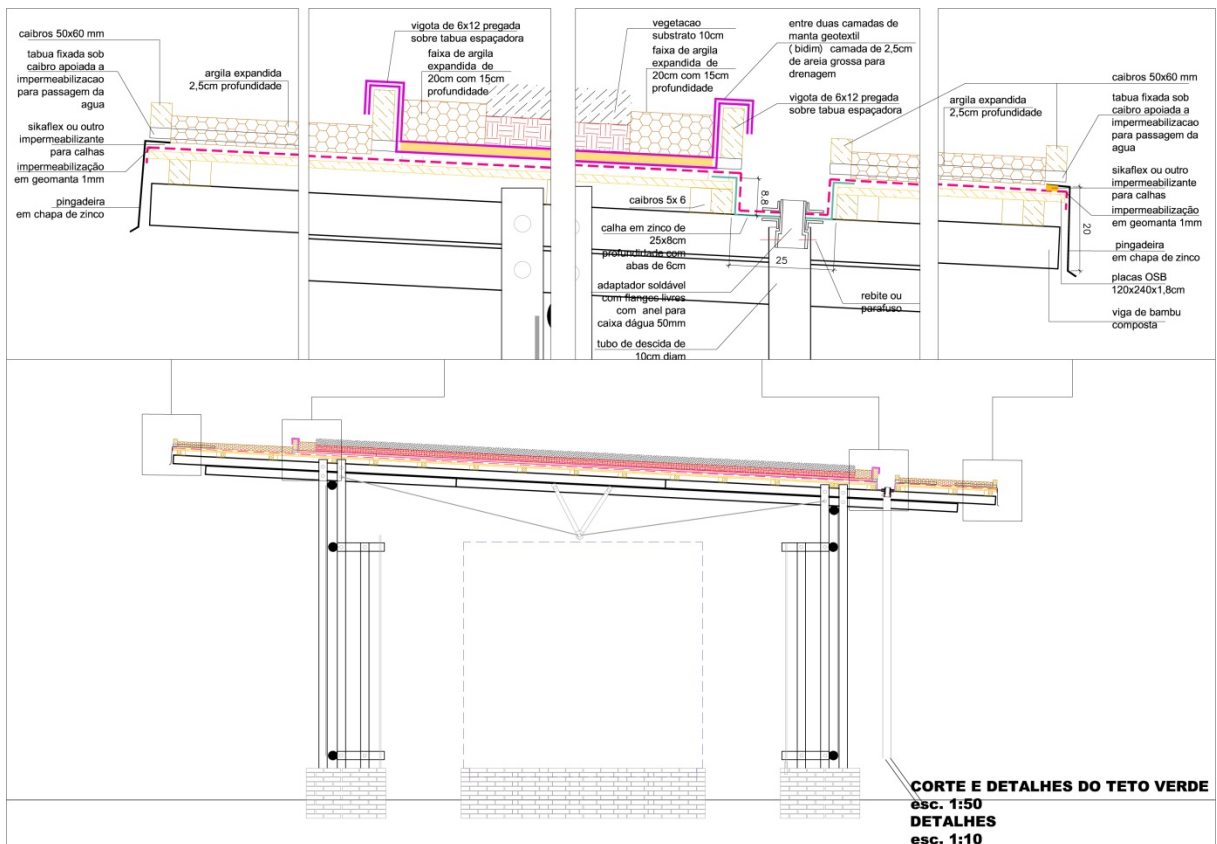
Projeto da cobertura verde (Munhoz R., janeiro 2011).
